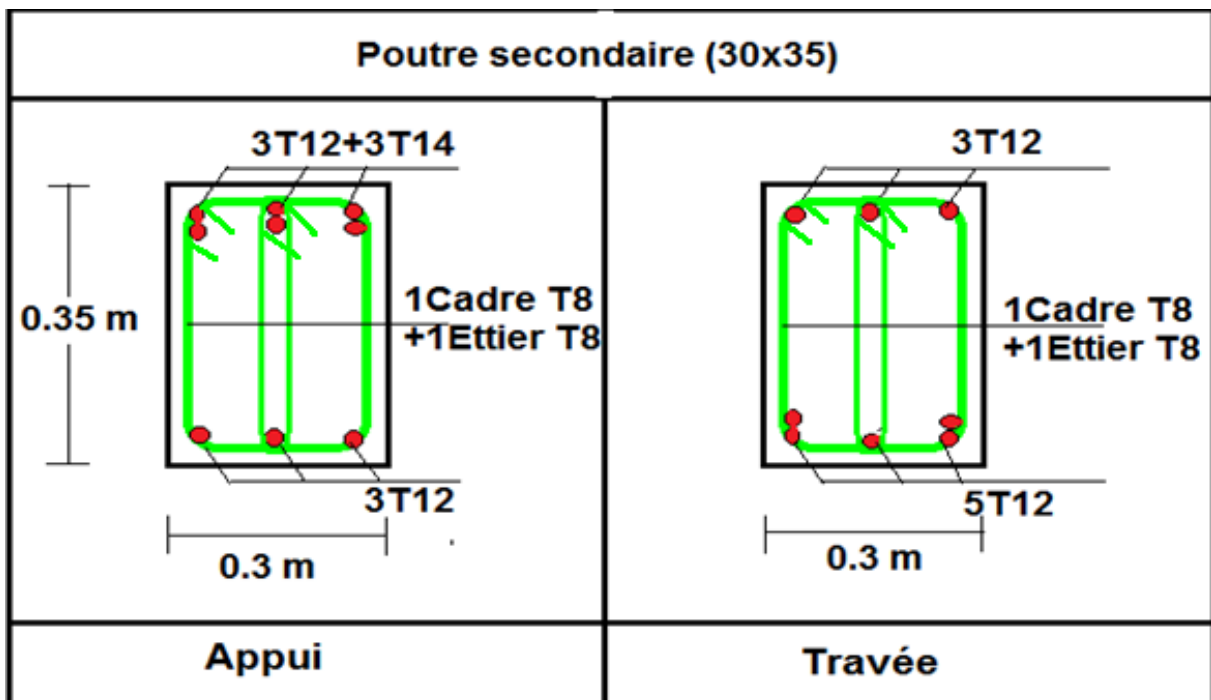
Ferraillage des Poutres secondaires de tous les étages
